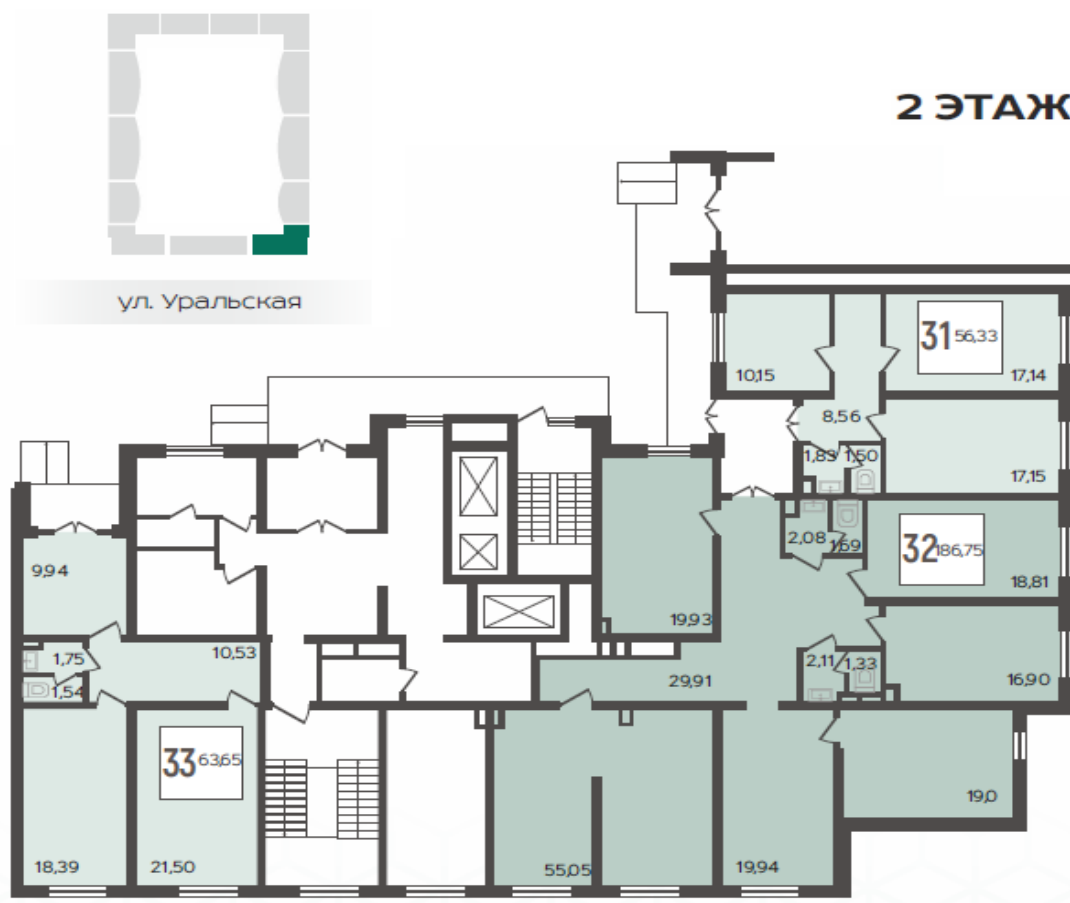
План коммерческих помещений 2 этажа БС-12 ЖК URAL
